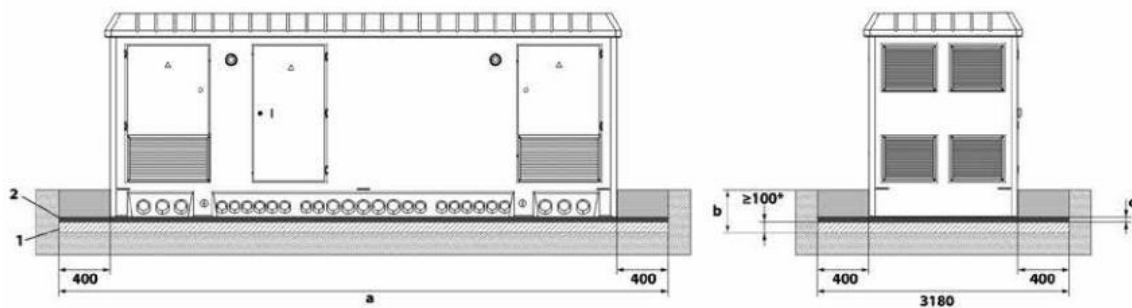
Planos de excavación CT. Fuente: ormazabal.com
